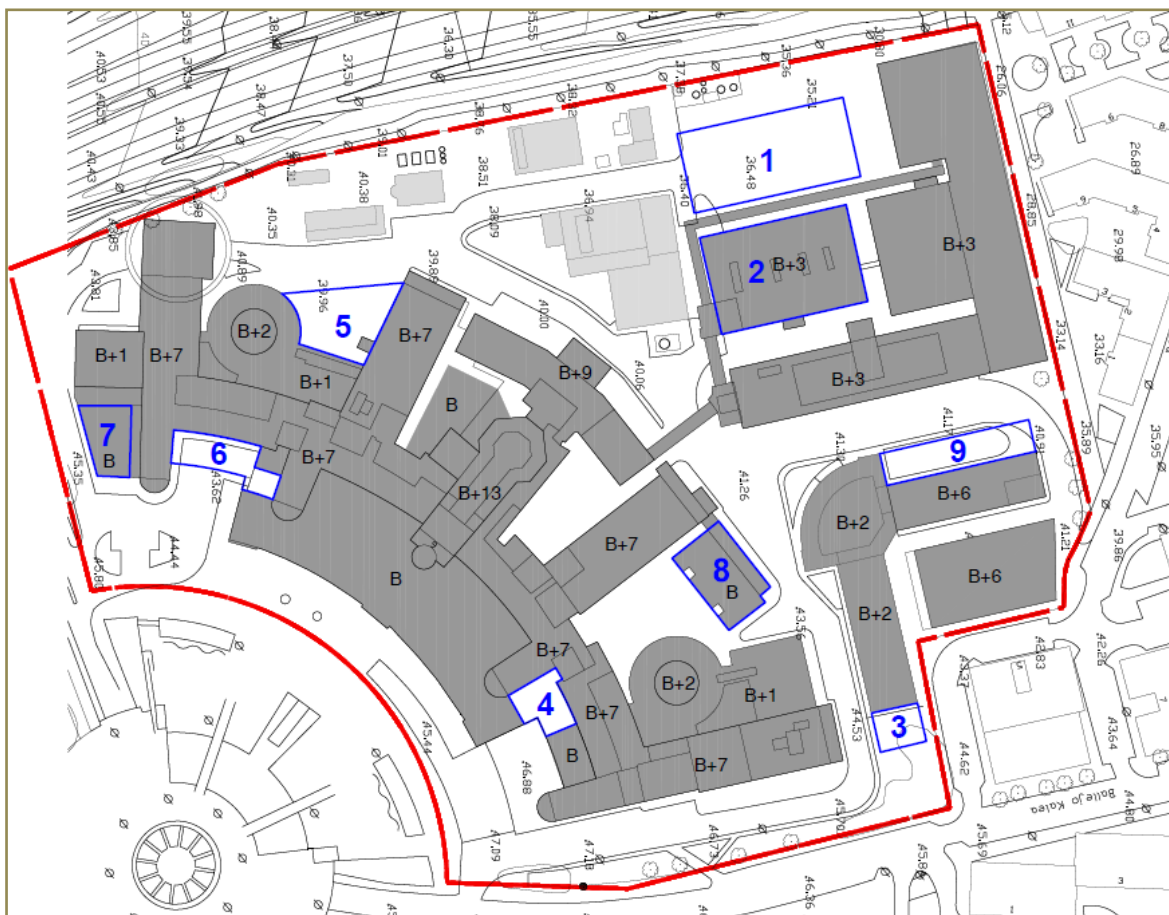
I: Ámbito y zonificación del Plan Especial
